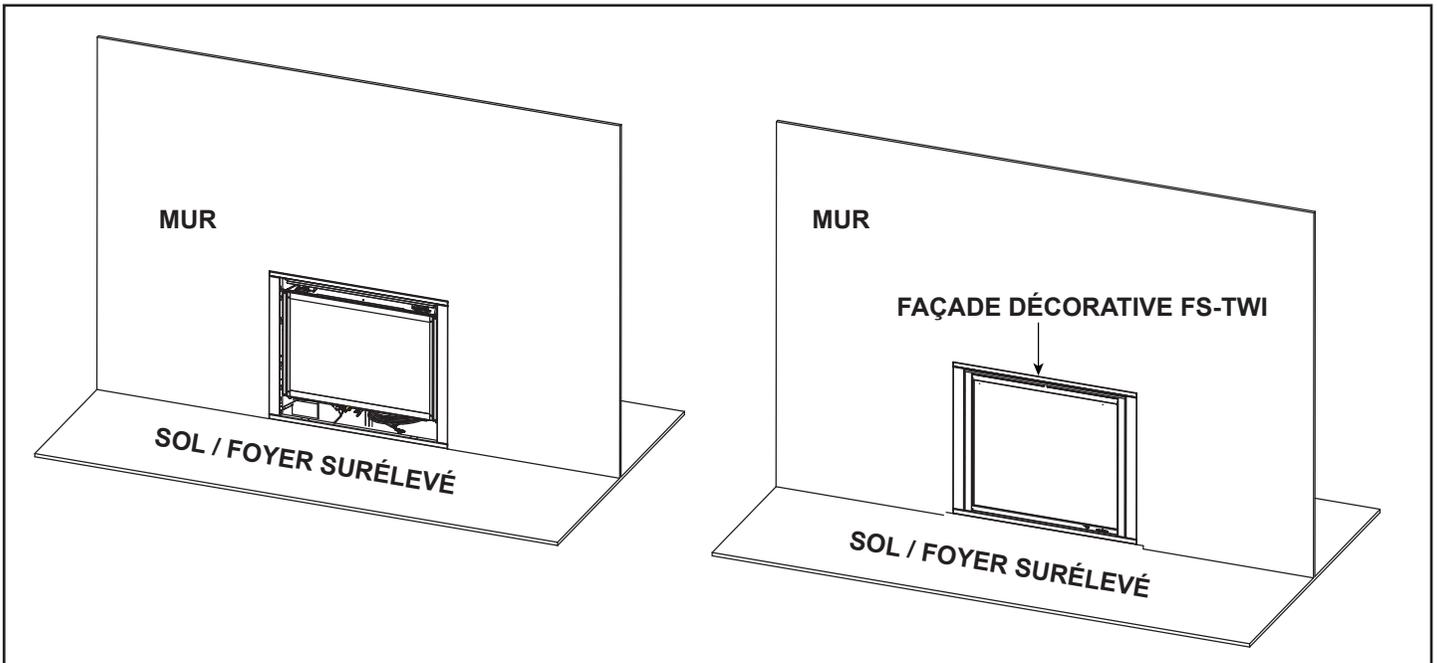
Appareil installé sur un plancher ou sur un foyer surélevé
